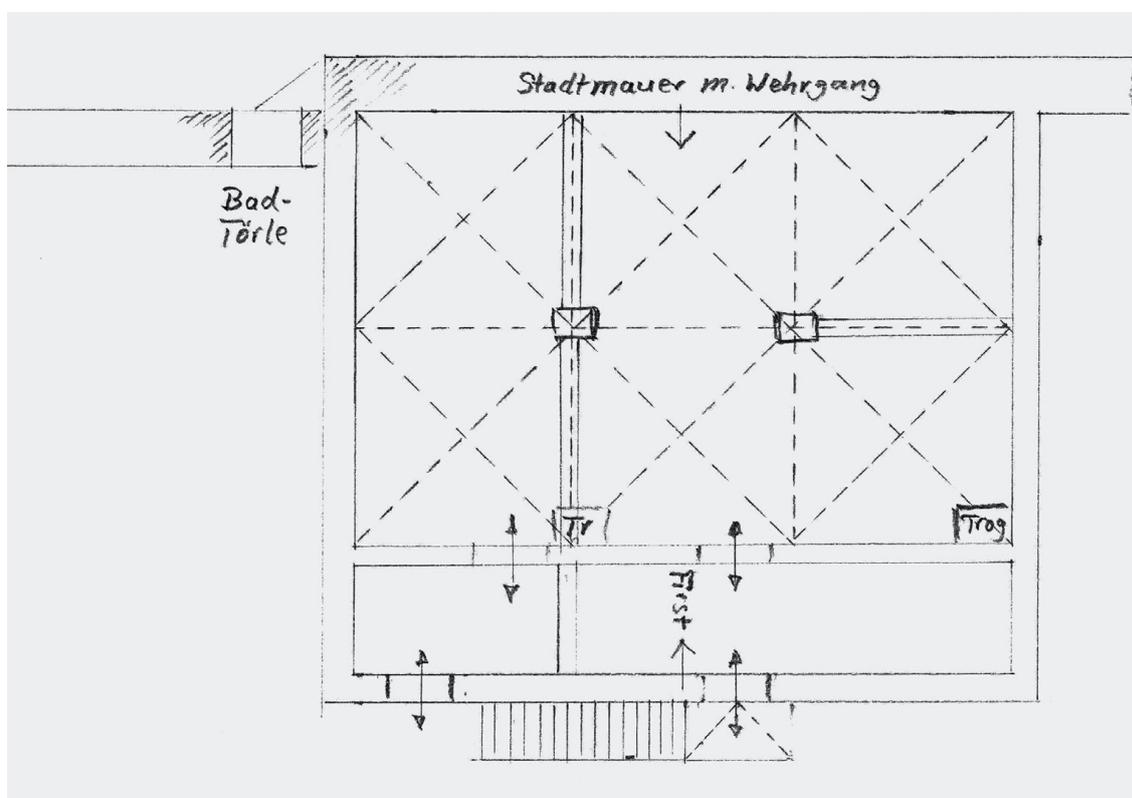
Skizze zum Grundriss Untergeschoss des sog. „Judenbads“.
